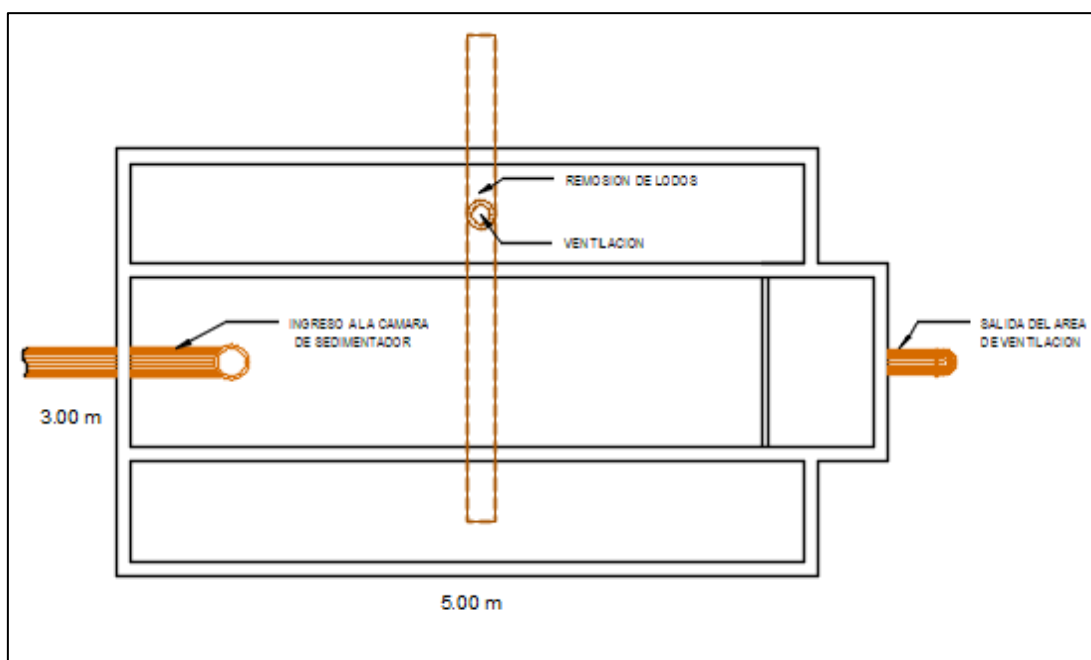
Esquema en planta del Tanque Imhoff Existente en la PTAR.
